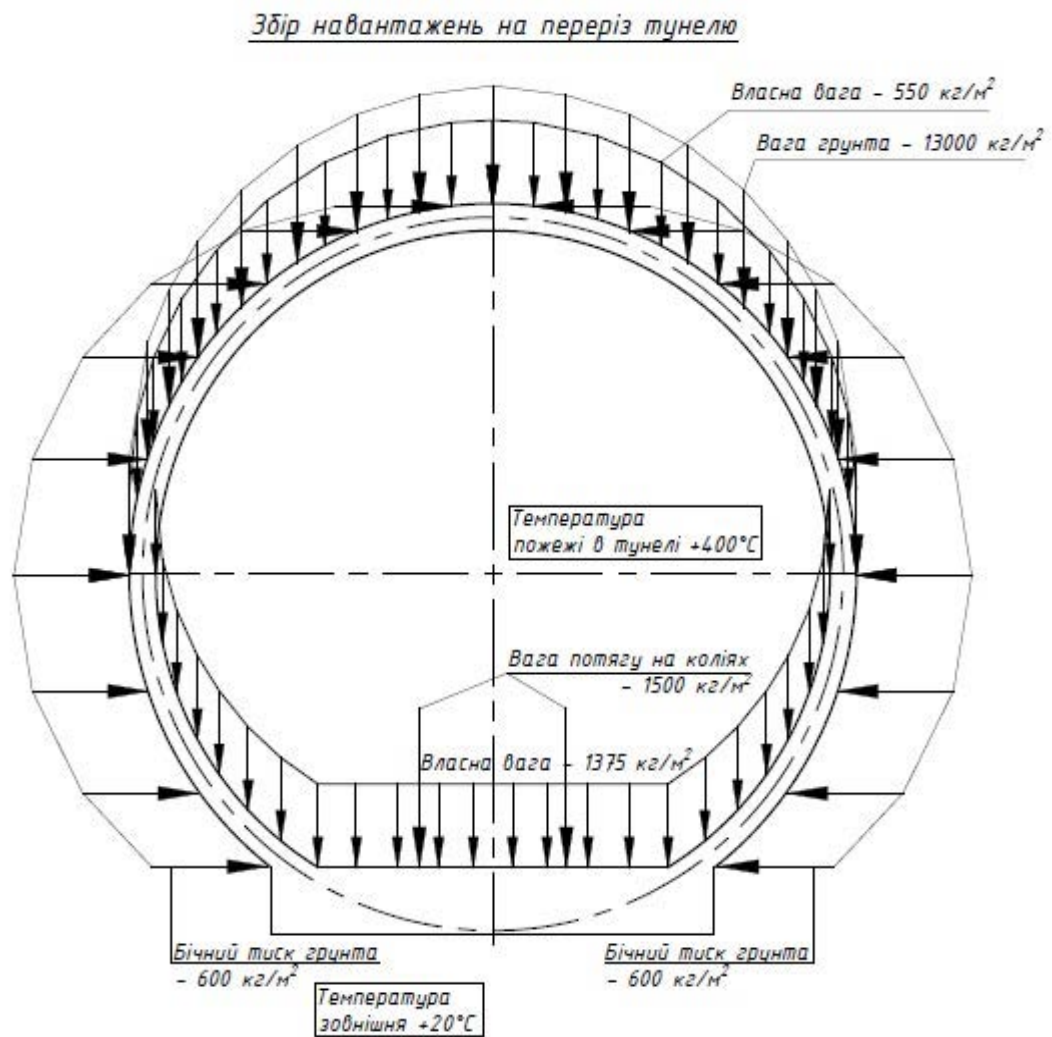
Розрахункова схема тунелю метрополітену з навантаженнями
